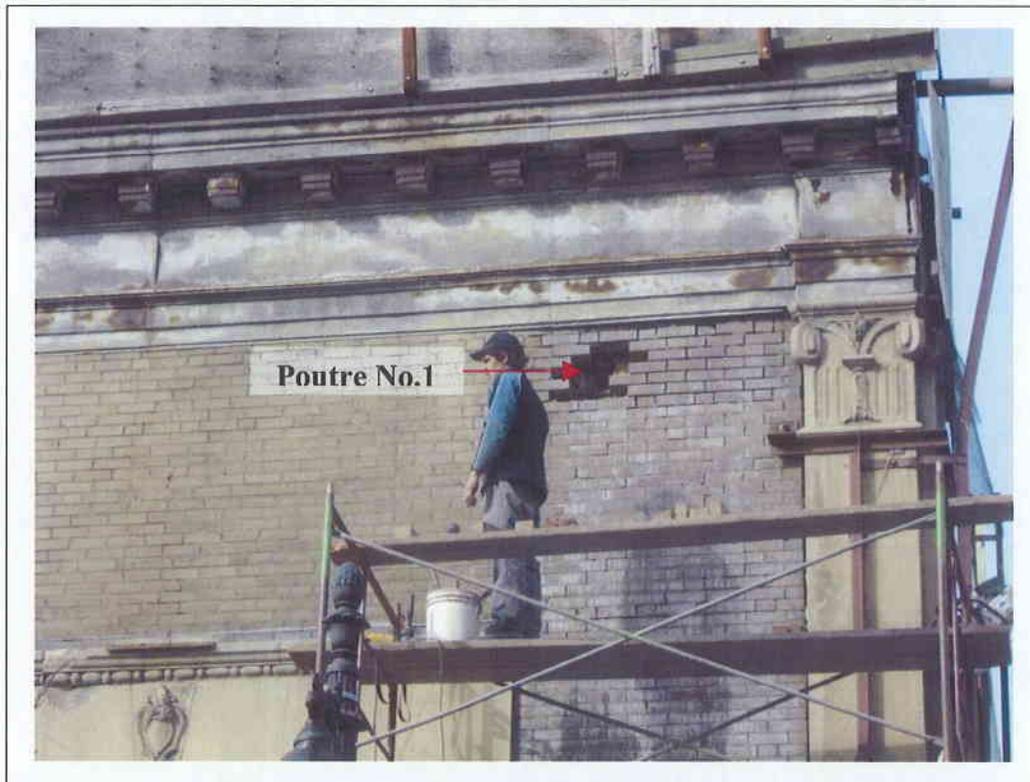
Ouverture réalisée de l'extérieur, au niveau de la poutre référencée sur la photo No. 10 en tant que « Poutre No. 1 ».
